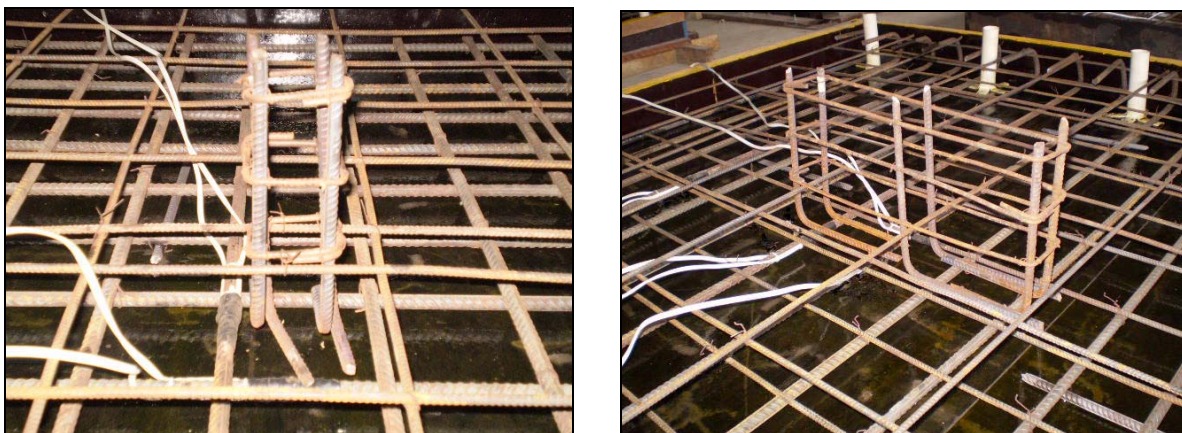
Armadura dos pilares das lajes L1A e L3B
